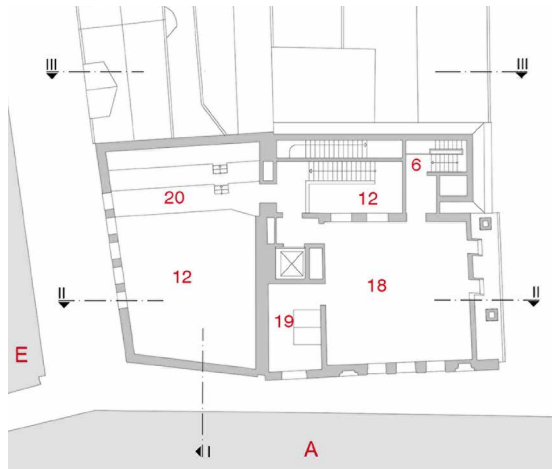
Figurentheater; Grundriss 1. OG [© Konermann Sigmund Architekten BDA Stadtplaner]
